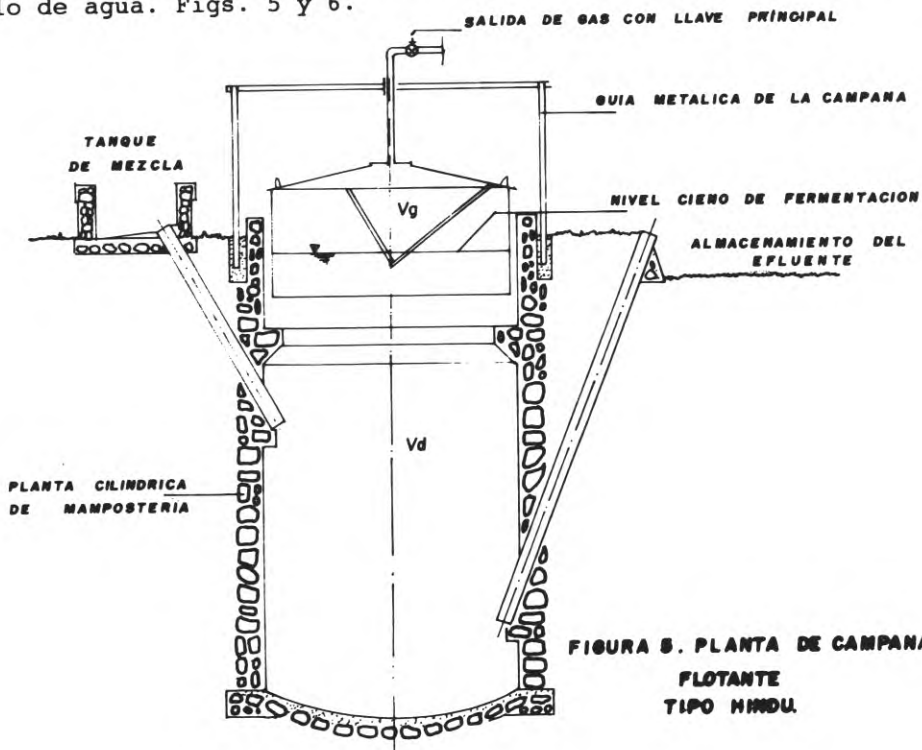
PLANTA DE CAMPANA FLOTANTE TIPO HINDU.
